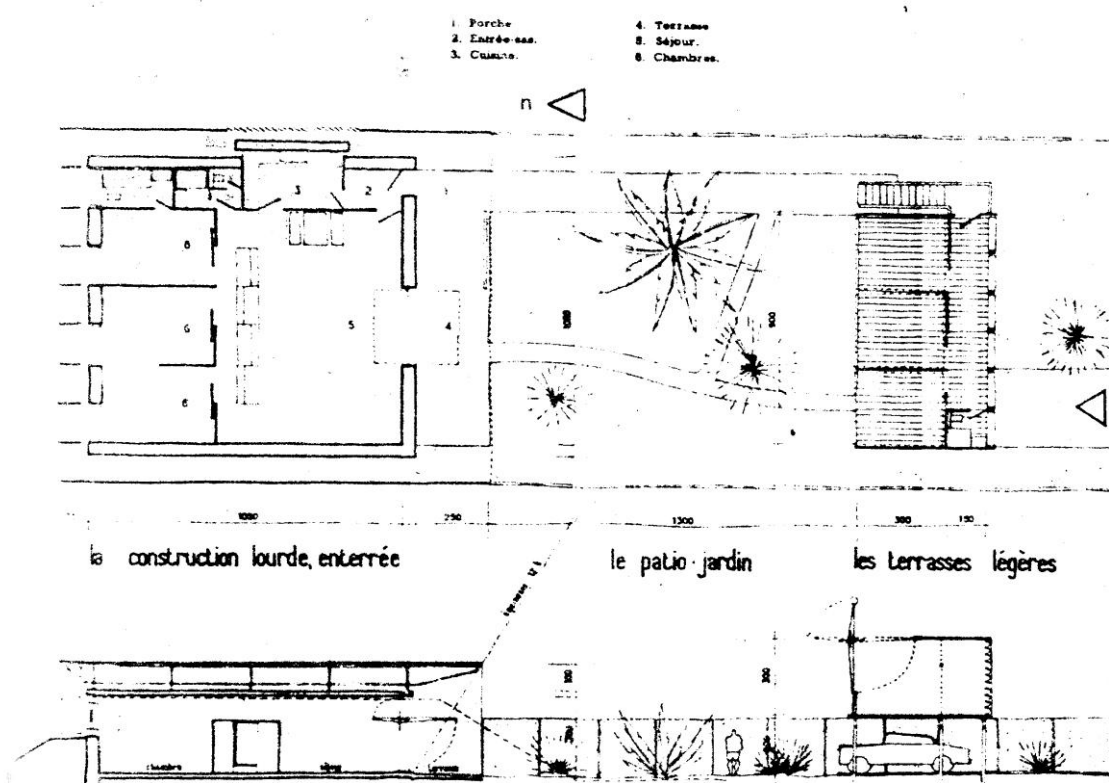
6 en haut le plan de la proposition, en bas une coupe longitudinale,
